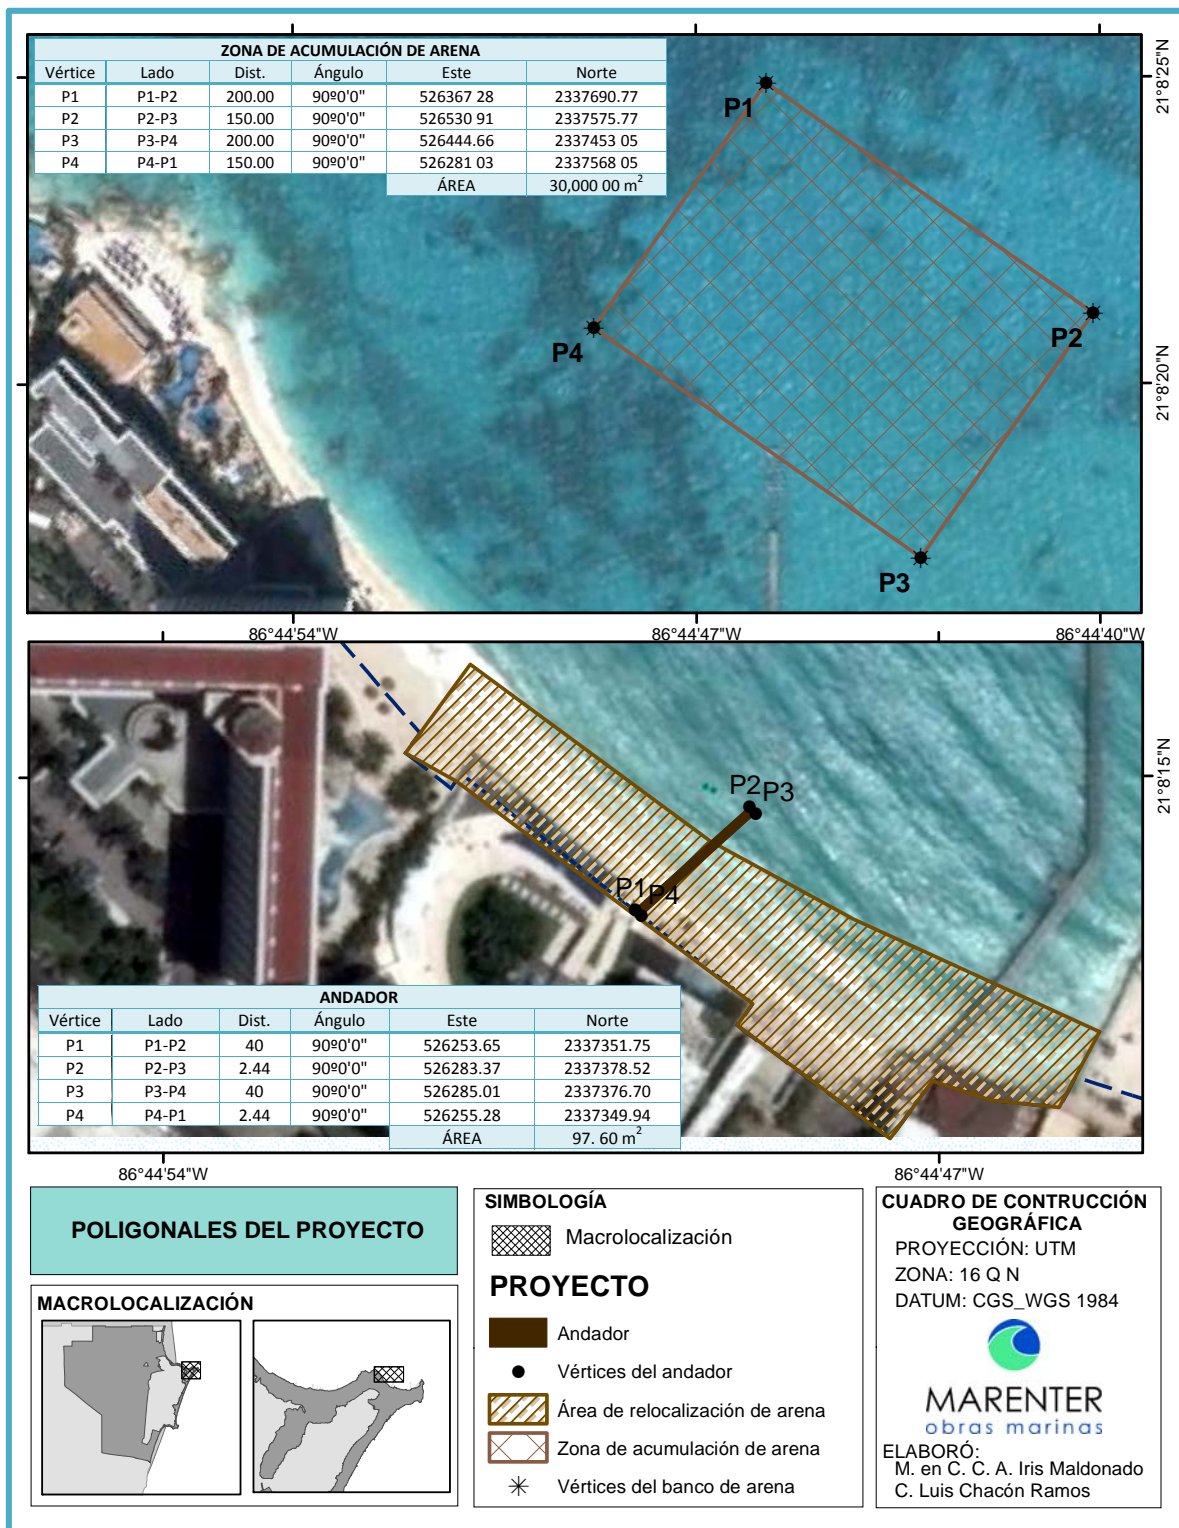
Plano de poligonales y coordenadas del proyecto.
